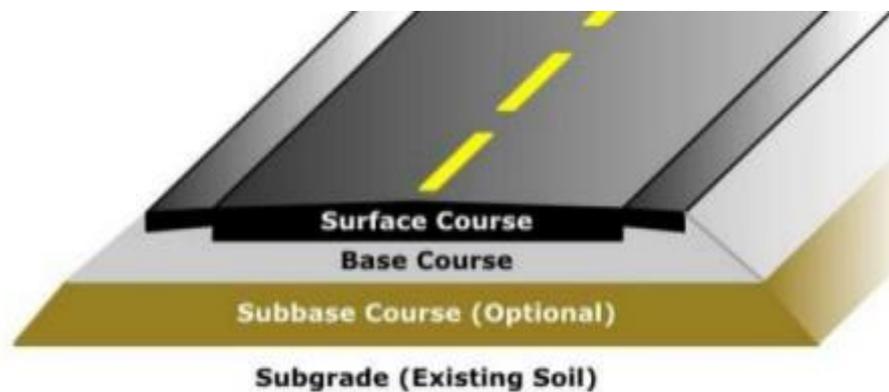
Esquema Típico del paquete Estructural de un pavimento Flexible
